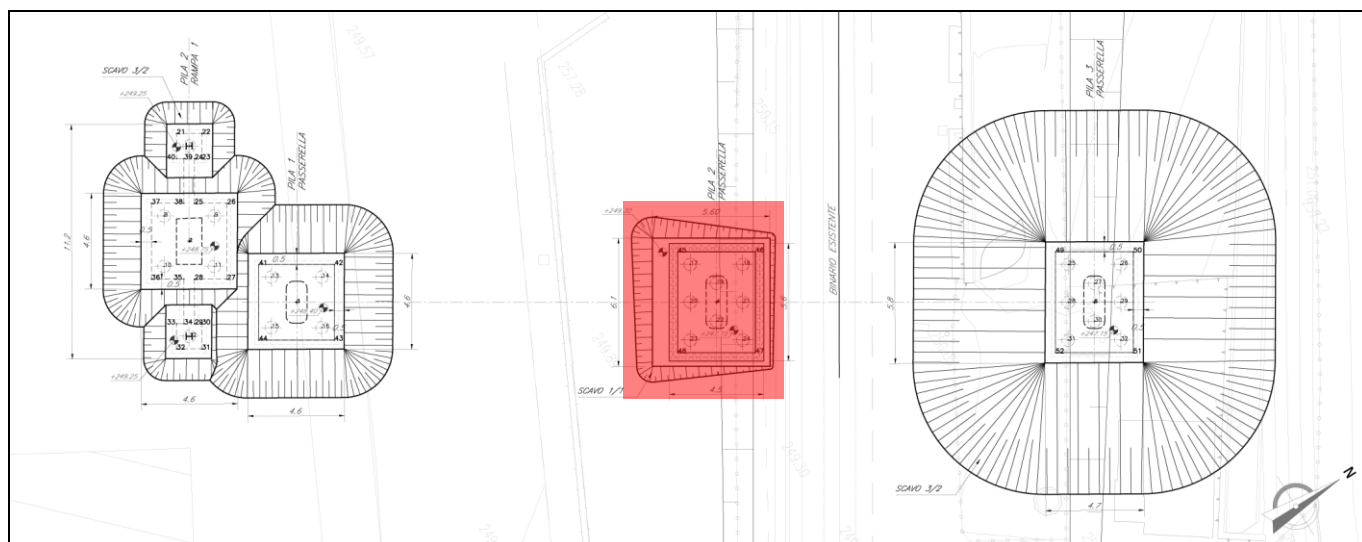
Stazione Vigna di Valle – Planimetria, pianta scavi – Ubicazione paratia della pila 2 della passerella
